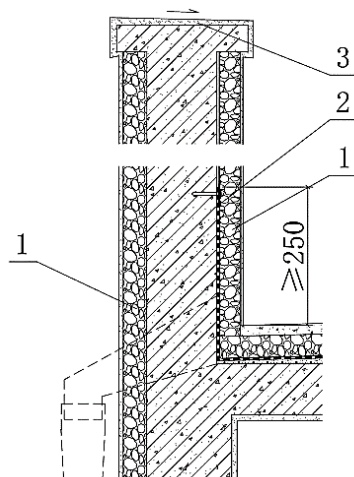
女儿墙保温做法示意图（钢筋混凝土）
